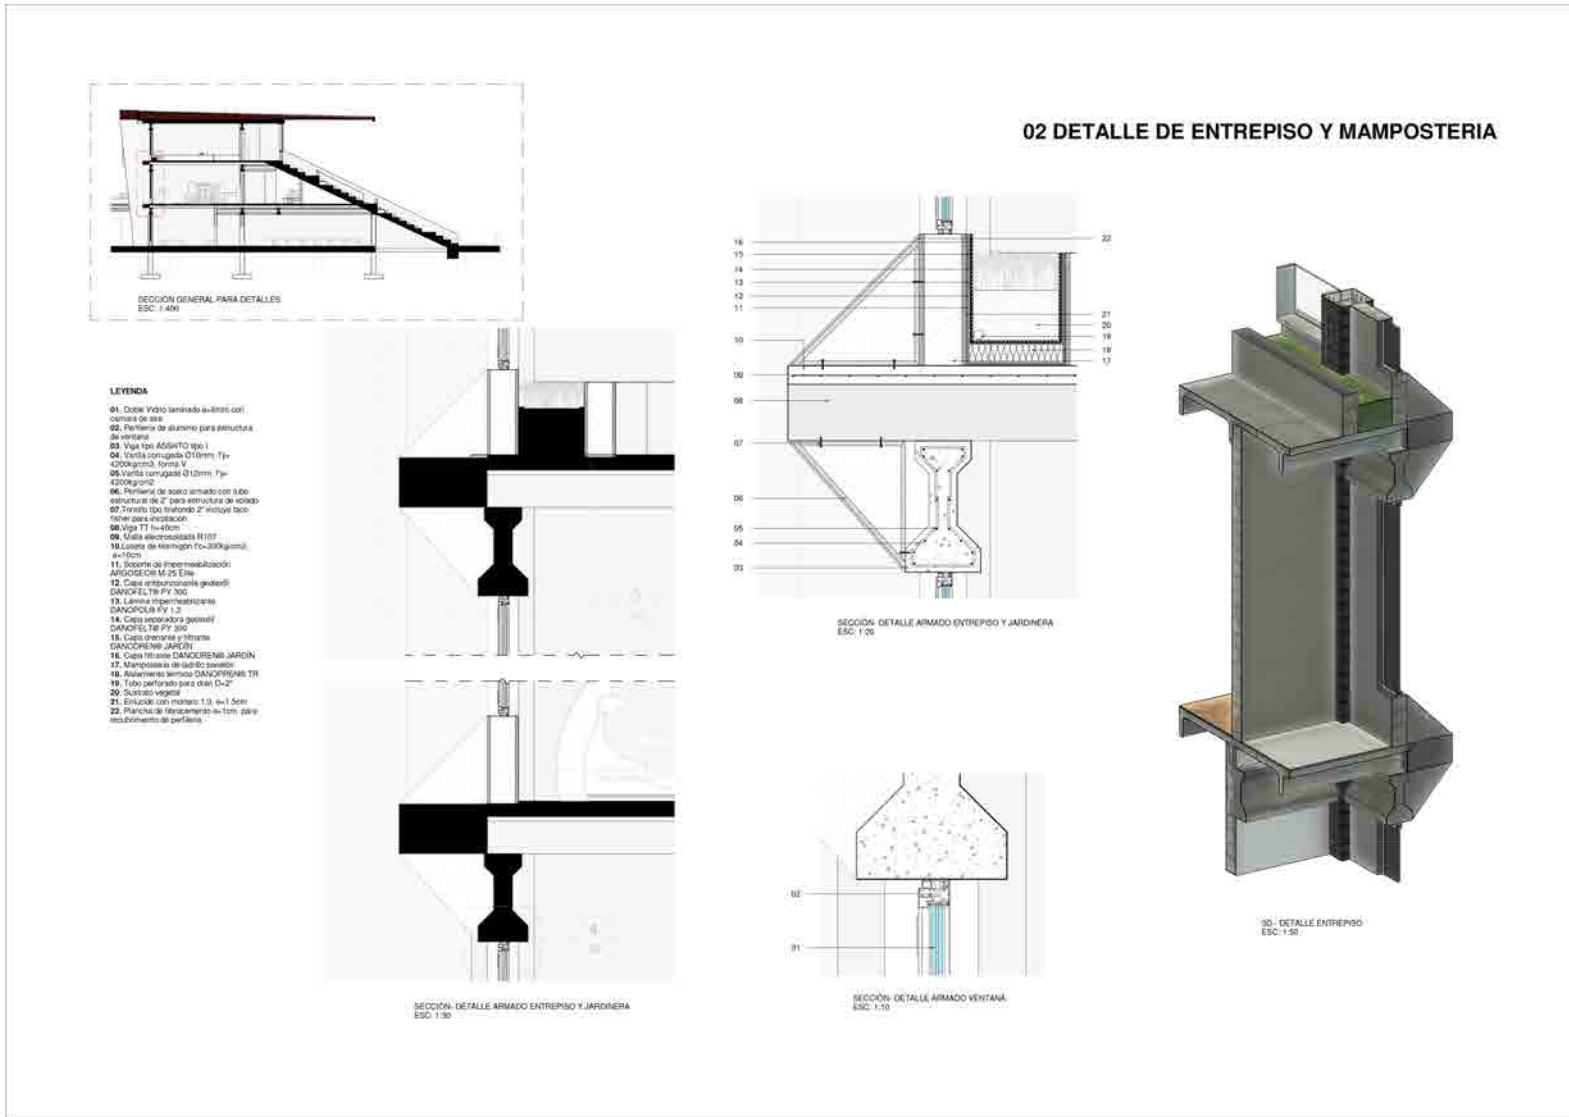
Detalle de entrepiso y mampostería. Elaboración: Autores.
